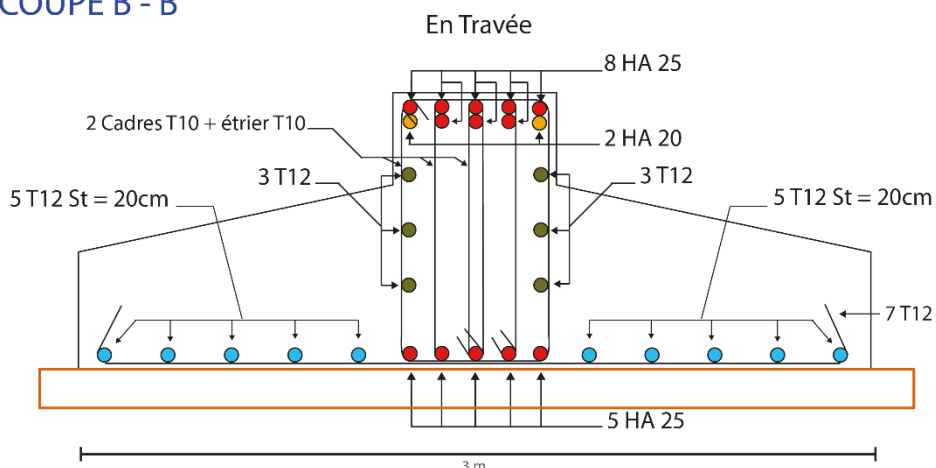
Schéma de ferrailage de la semelle filante en travée « coupe transversal B-B' ».
